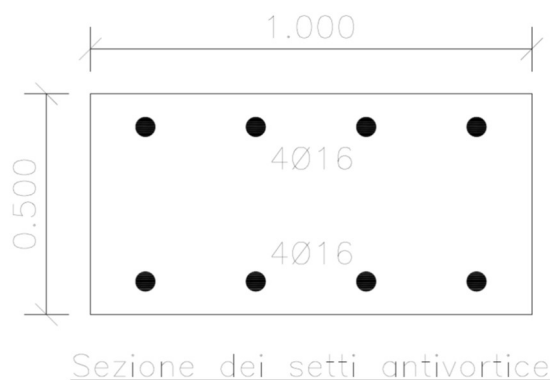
Sezione di 1 metro lineare di setto antivortice con indicazione delle armature utilizzate
